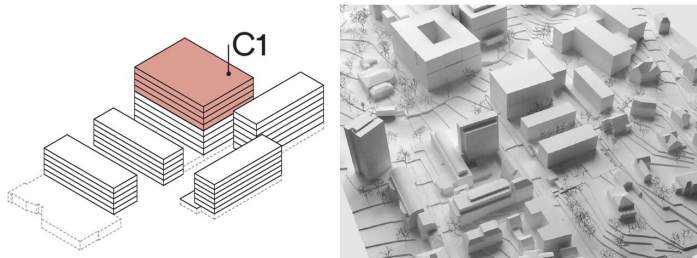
Aufstockung Hauptgebäude C1, Isometrie mit Darstellung der Geschosshöhe und Modellansicht
